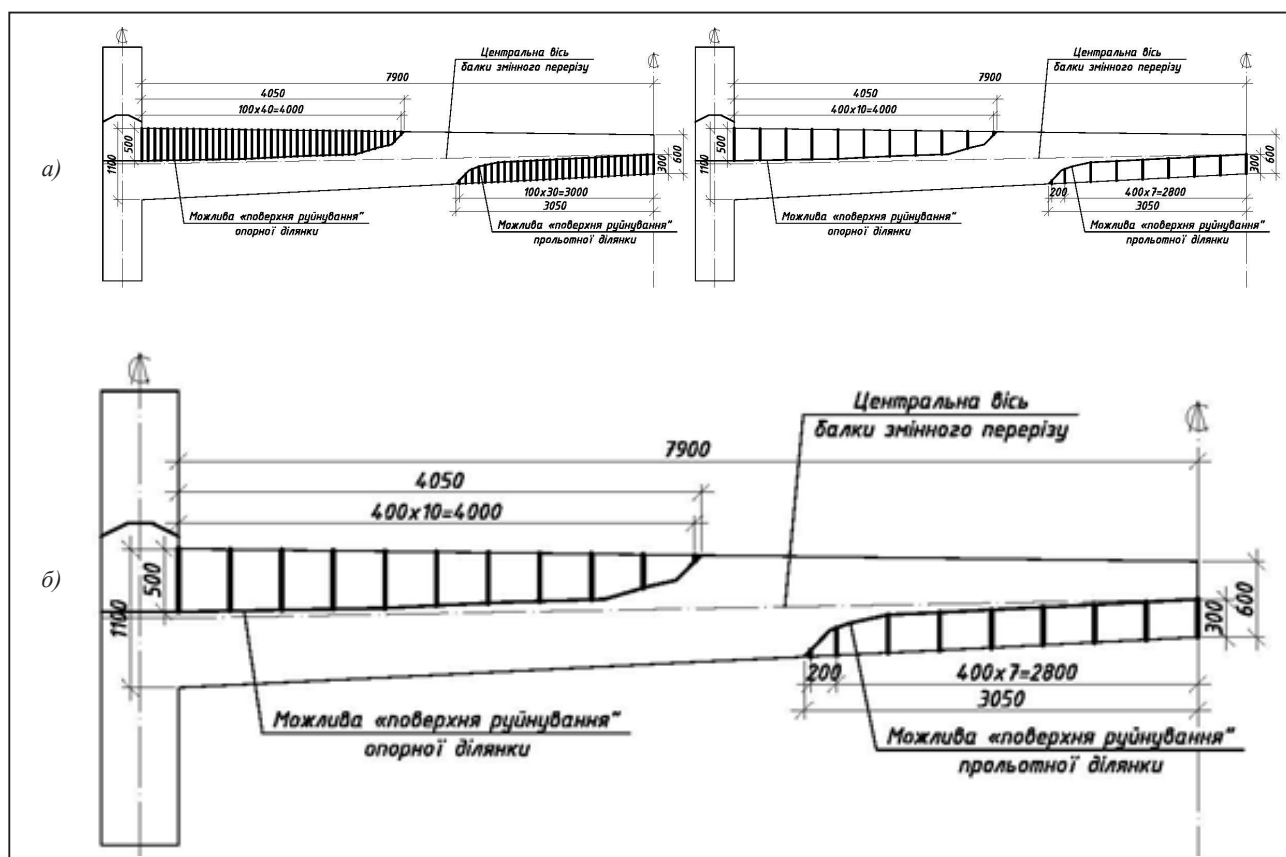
Схеми розташування введених розривів (нормальних тріщин) у зоні можливої «поверхні руйнування» залізобетонної балки змінного поперечного перерізу: а) 10 см, б) 40 см
